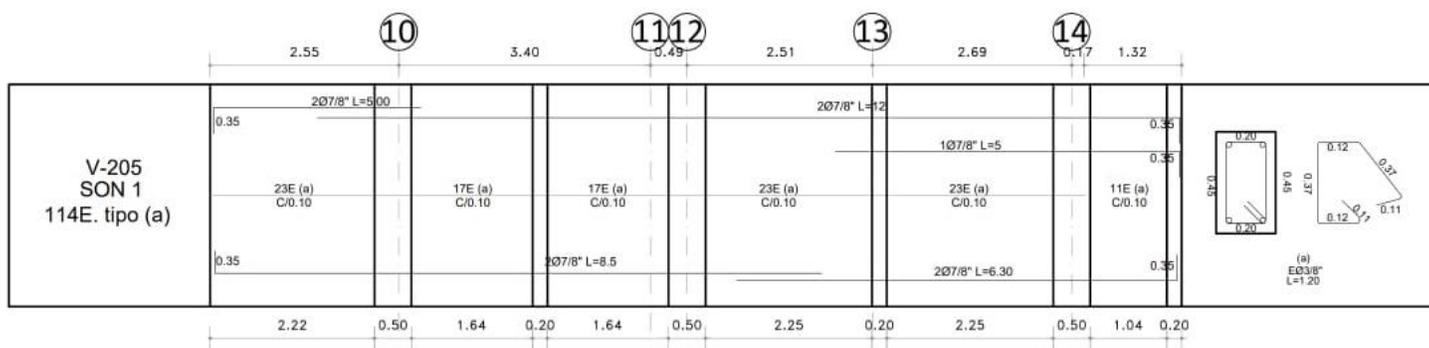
Viga 0.20x0.45 y Sección Estructural 205.
